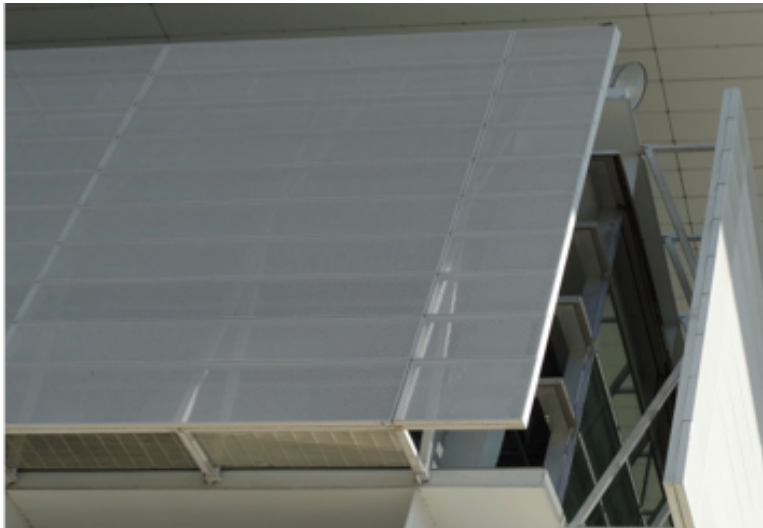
Protectores solares Fuente. D. Adame Arcos 201
